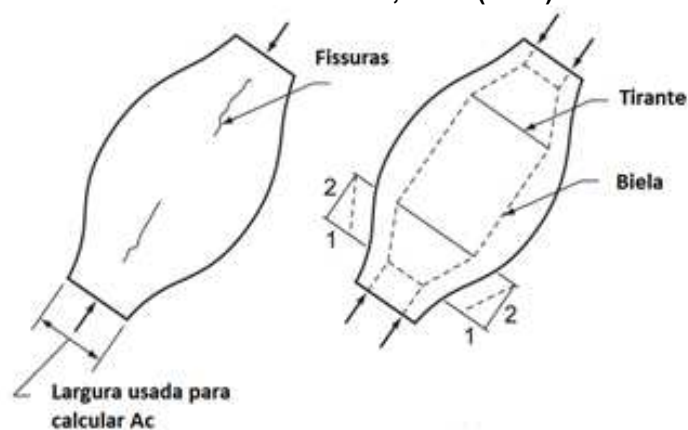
Fissuras nas extremidades da biela, Silva (2017)
